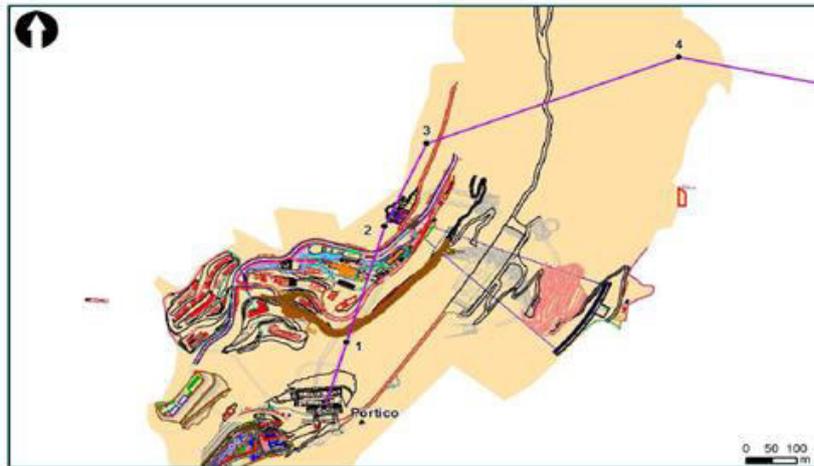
Implantação do projeto sobre a área de estaleiro do AHFT.
